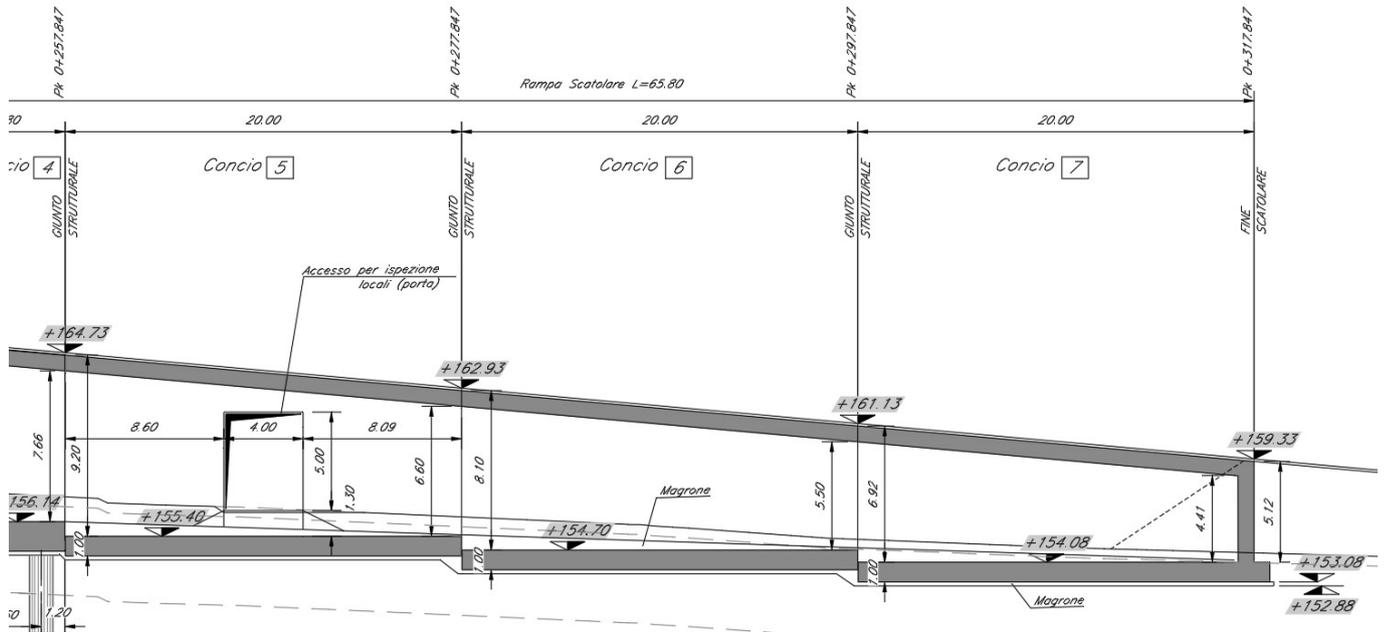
Sezione longitudinale – Rampa lato Trieste
